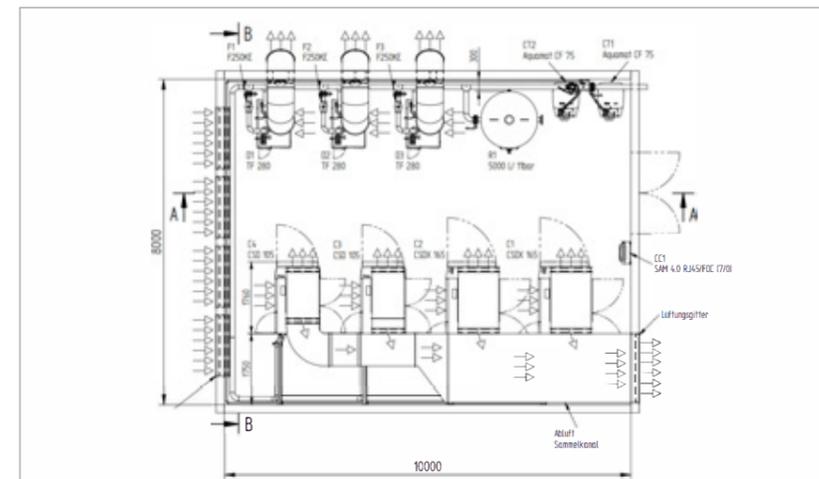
Plan d'ensemble d'une station d'air comprimé
